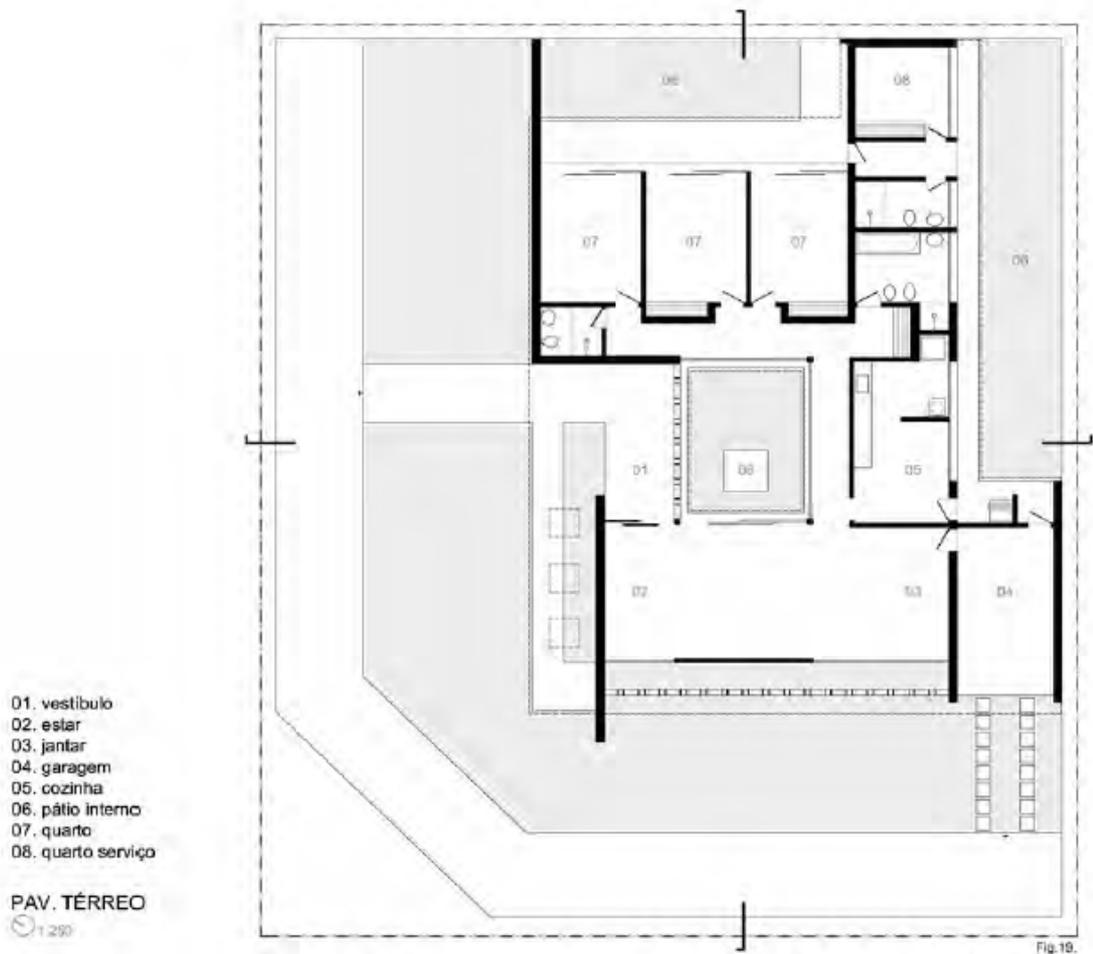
| PLANTA DO PAVIMENTO TÉRREO CASA JOSÉ FELIX LOUZA – ARQUITETO DAVID LIBESKIND, 1965. SILVA NETO, 2010.
